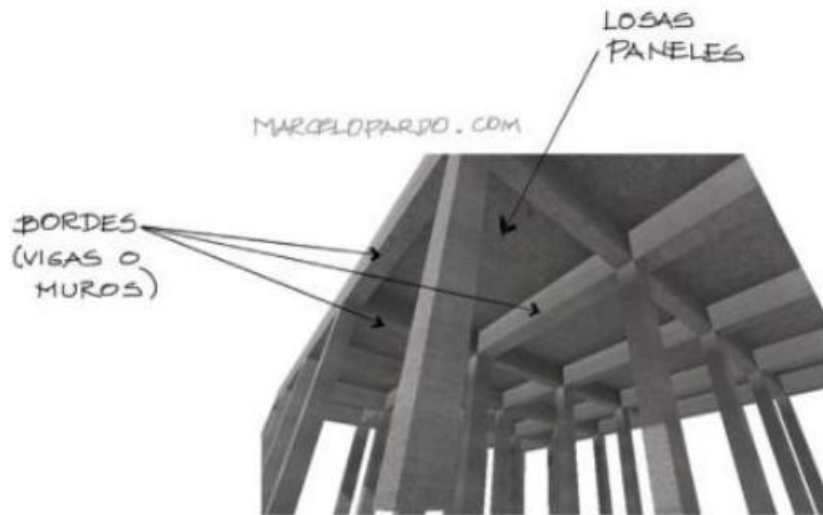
Losa plana con vigas peraltadas [Pardo,2011]
